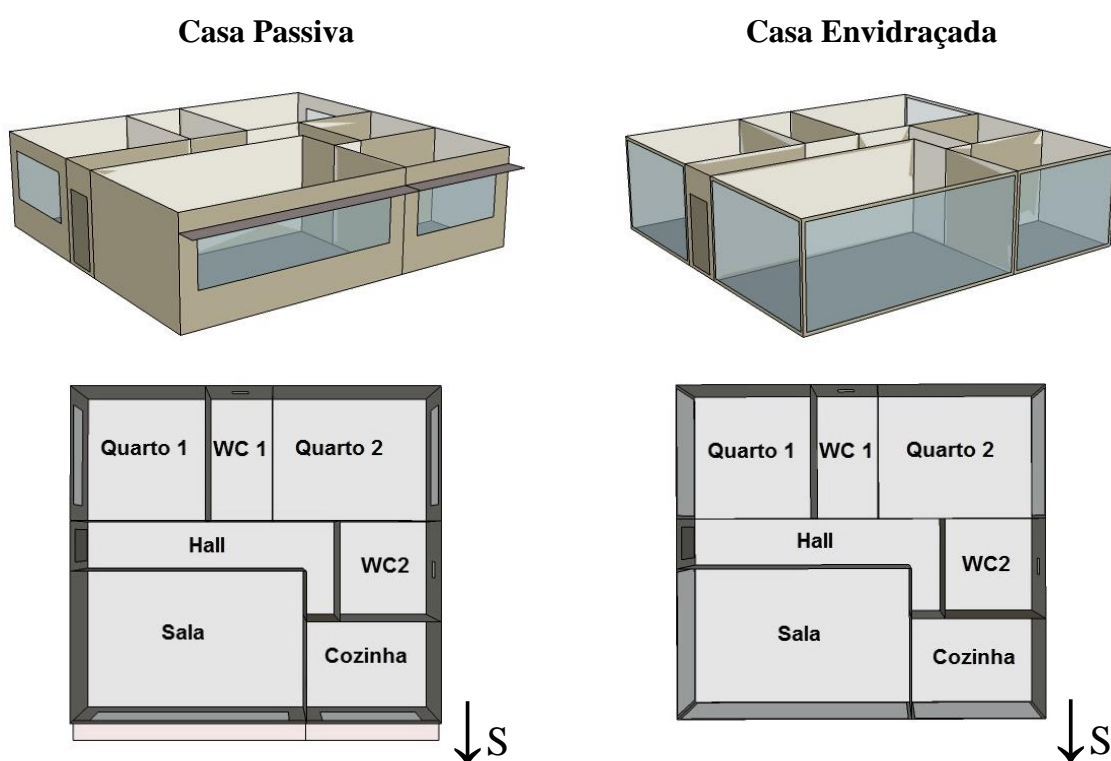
Arquitetura e planta da casa passiva e da casa envidraçada. (Graça, 2006)
